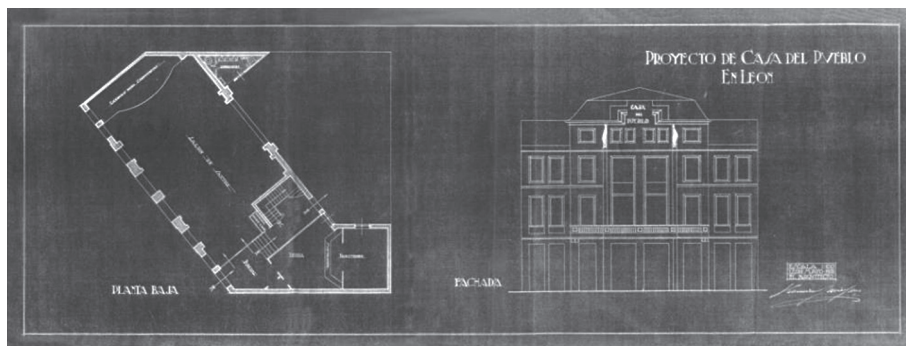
Plano de la fachada y planta de la Casa del Pueblo de León, años treinta.
